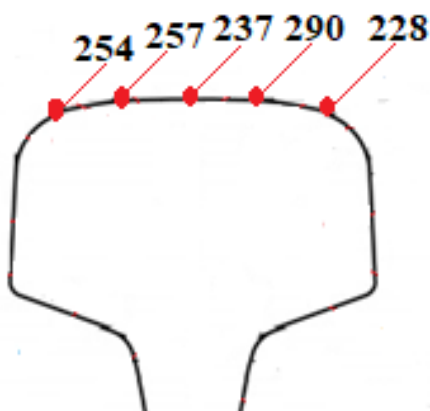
Измерение твердости металла (в кривой R = 956 м) на поверхности катания нового рельса ENSIDESA 05 13 60 E1
